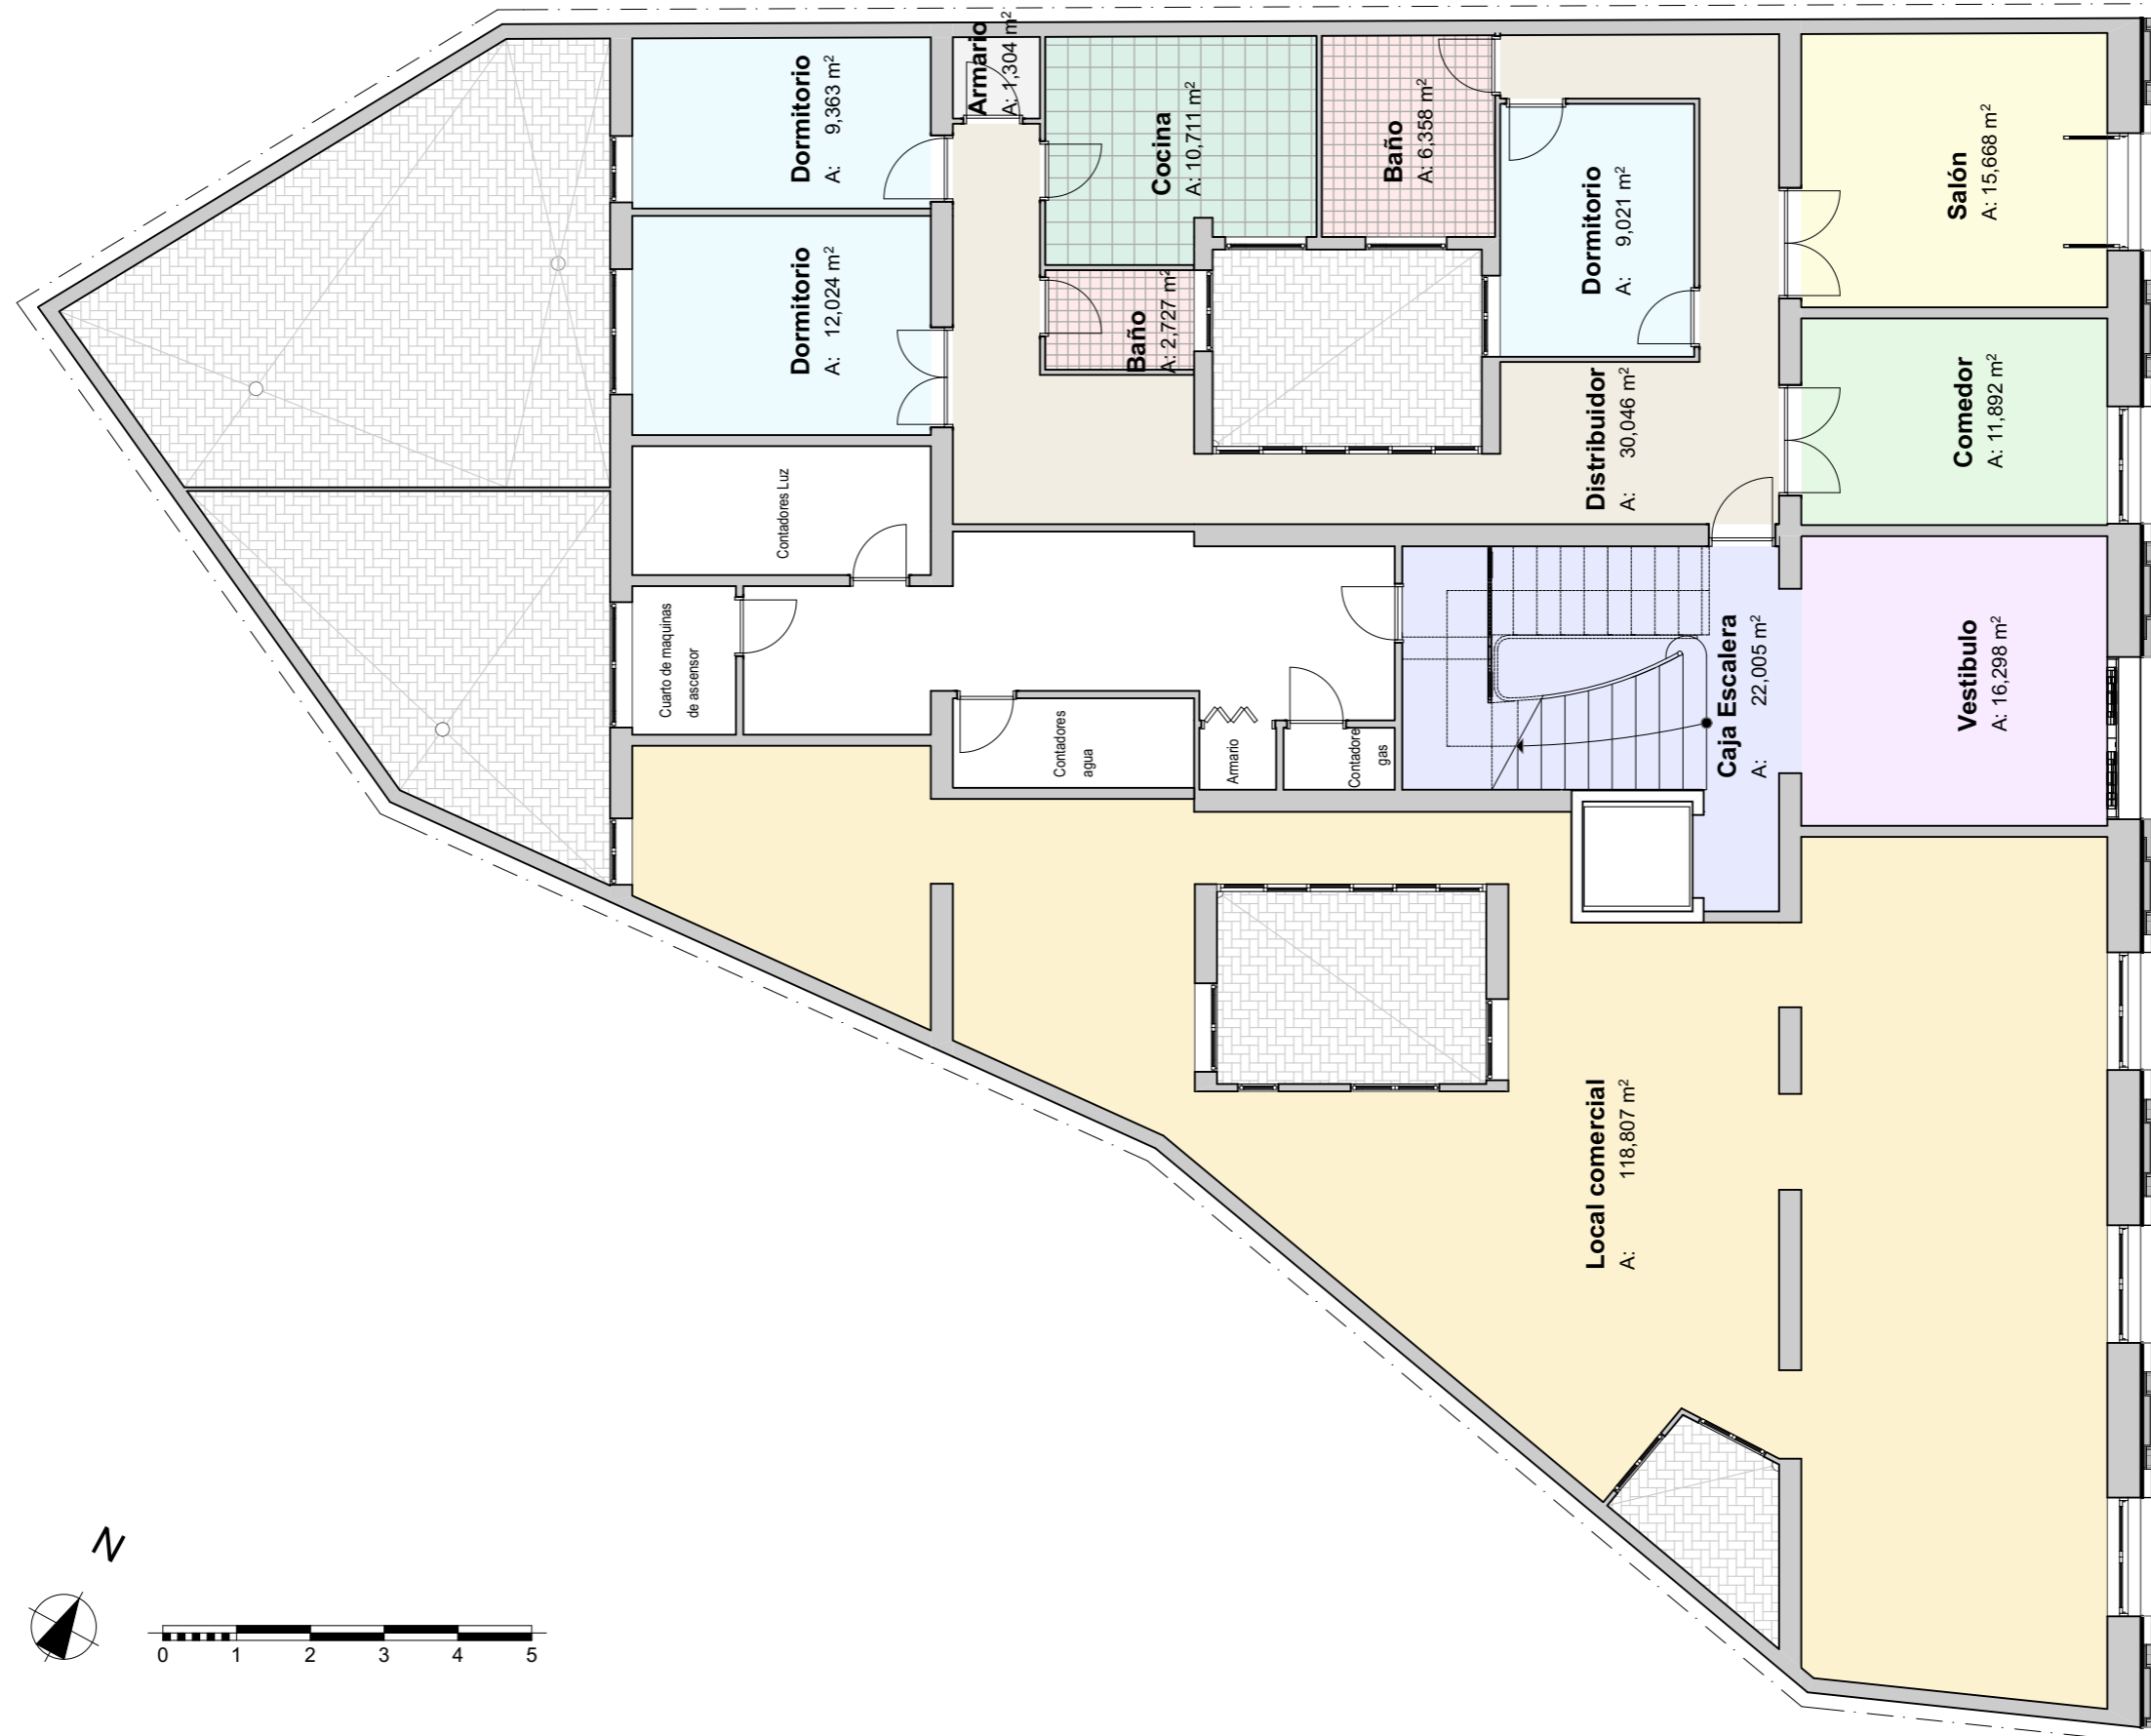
Zonificación estado original en planta baja de la memoria de 1996
